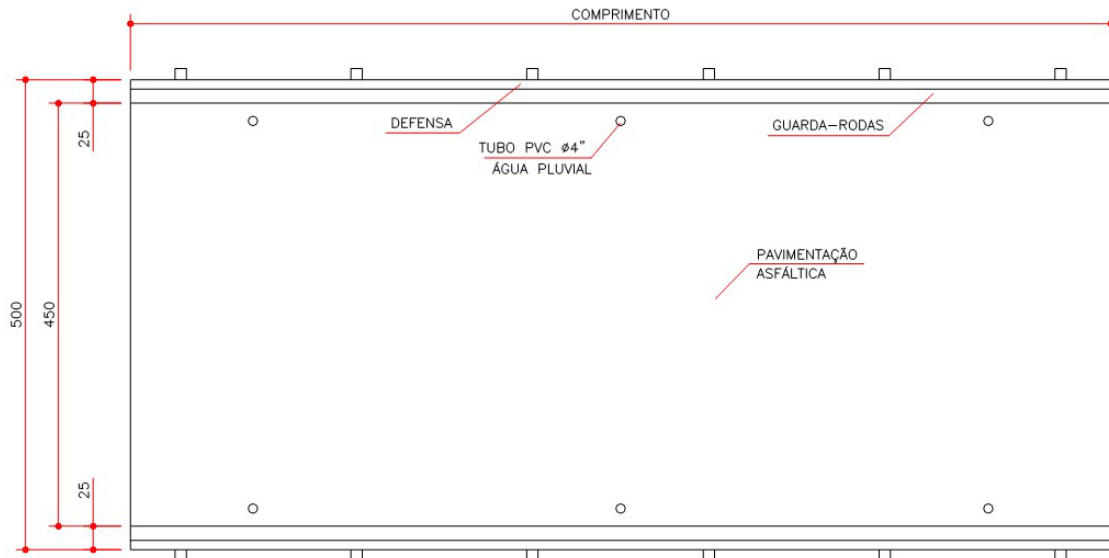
Vista superior da ponte em placa mista com peças de madeira roliça e concreto armado. Fonte: CALIL et al (2006).
